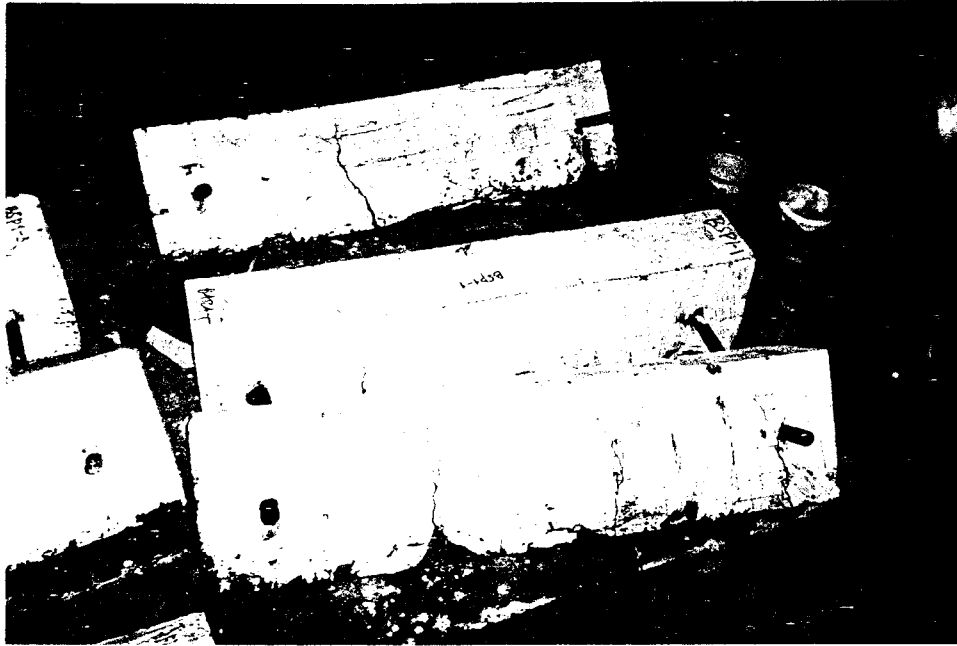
Hasil pengujian balok BFS 2-2 (tampak depan).
